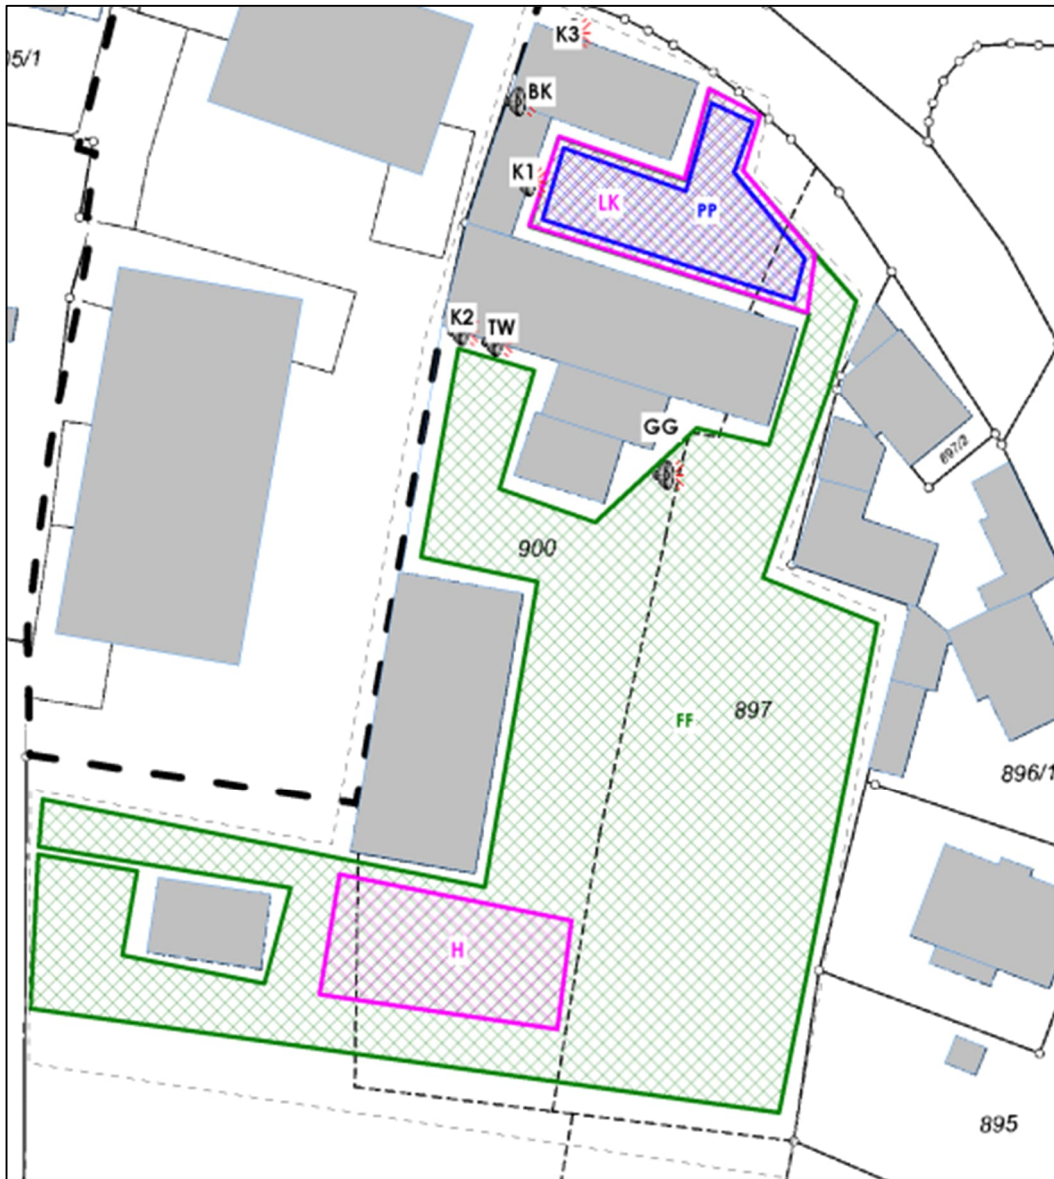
Lageplan mit Darstellung der relevanten Schallquellen
